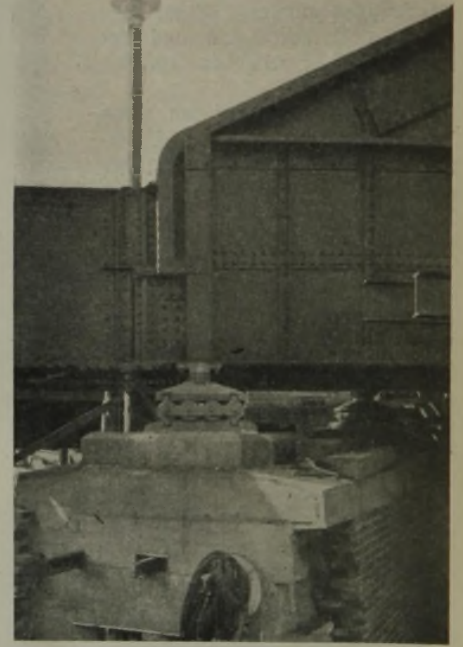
Gemeinsame Auflagerung der Überbauten auf dem Pfeiler.
